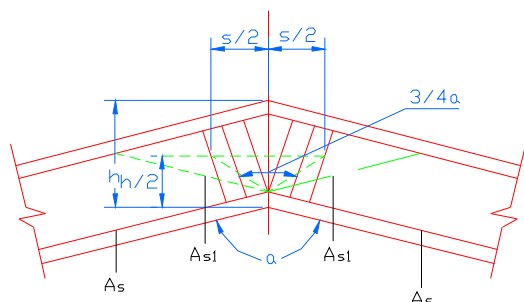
钢筋轻骨料混凝土构件内折角处配筋
